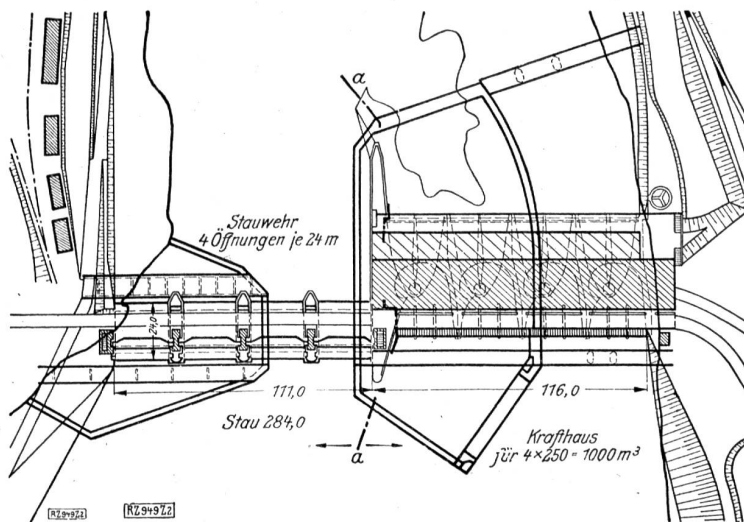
Lageplan des Stauwehres und des Maschinenhauses.
